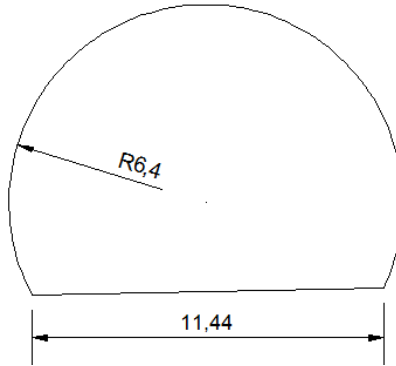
Sección transversal típica de túnel de carretera modelizada.
